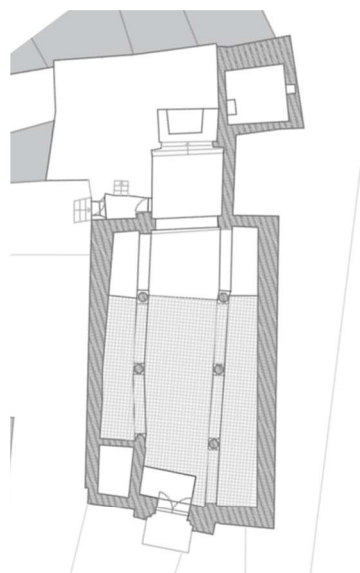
Reconstituição da planta de São Pedro na fase 2
